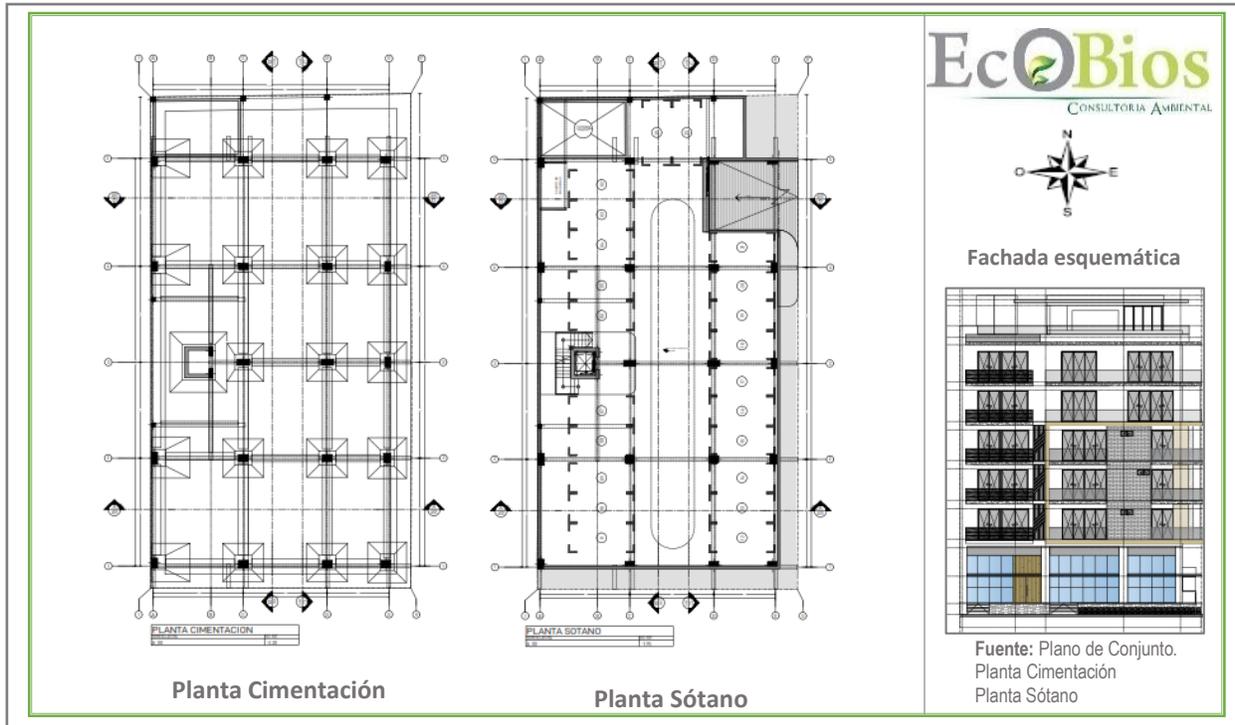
Detalle del diagrama del polígono Planta Cimentación y Planta Sótano
